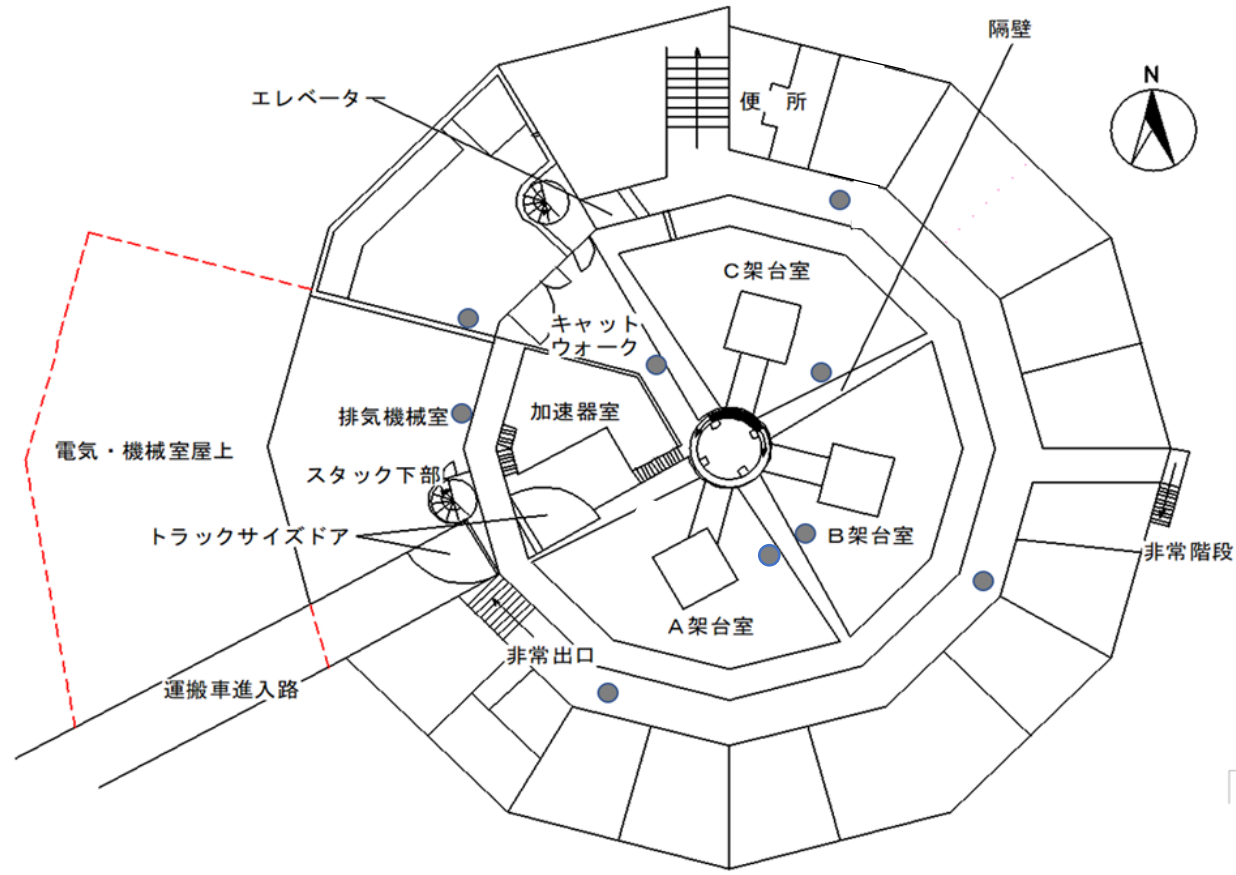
スピーカー配置図 (臨界集合体棟 2階平面図)
